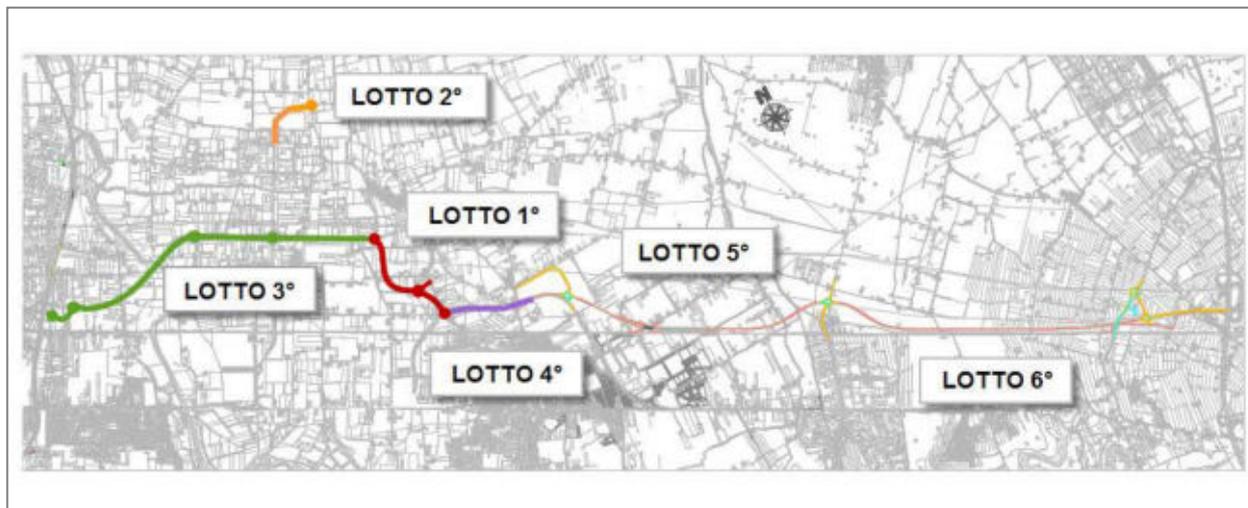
planimetria con l'ubicazione dei lotti della infrastruttura.
